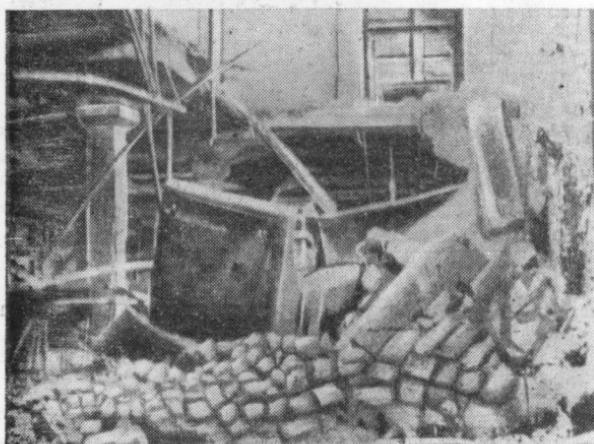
Обрушившееся колонна и перекрытие во время пожара.
